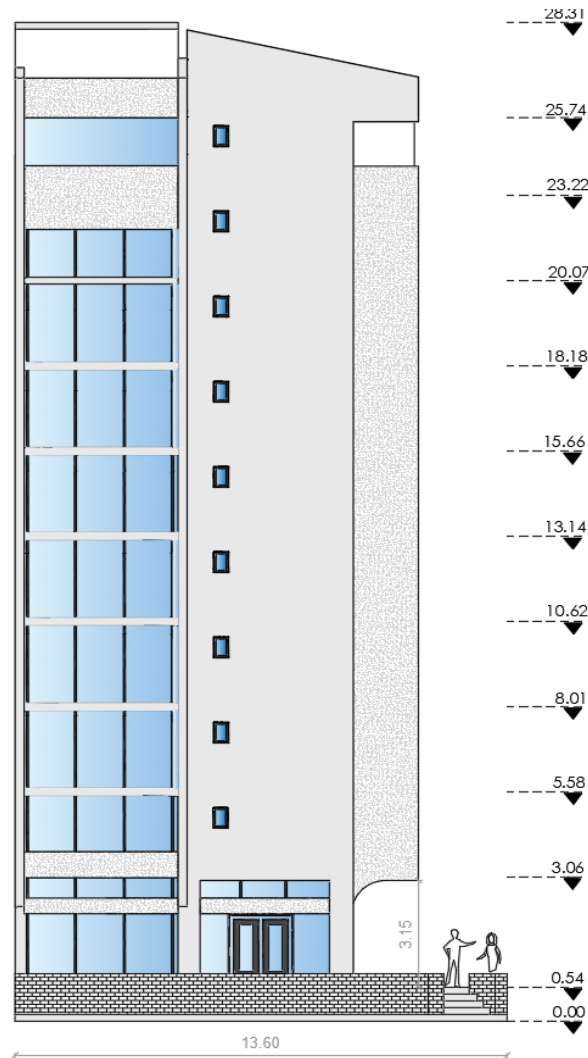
ESTOA edificio "El Ejecutivo". Elevación arquitectónica lado calle la granja.
